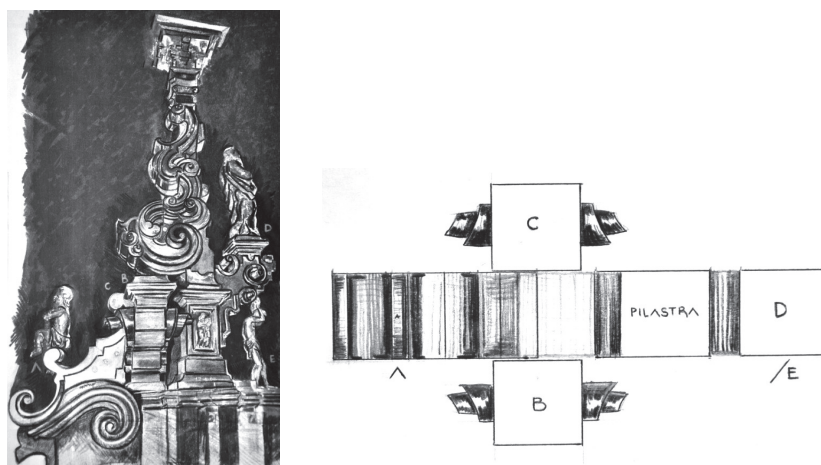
a-b. Alzado y planta de las pilastras del primer cuerpo. Dibujo Ricardo Cruzaley
